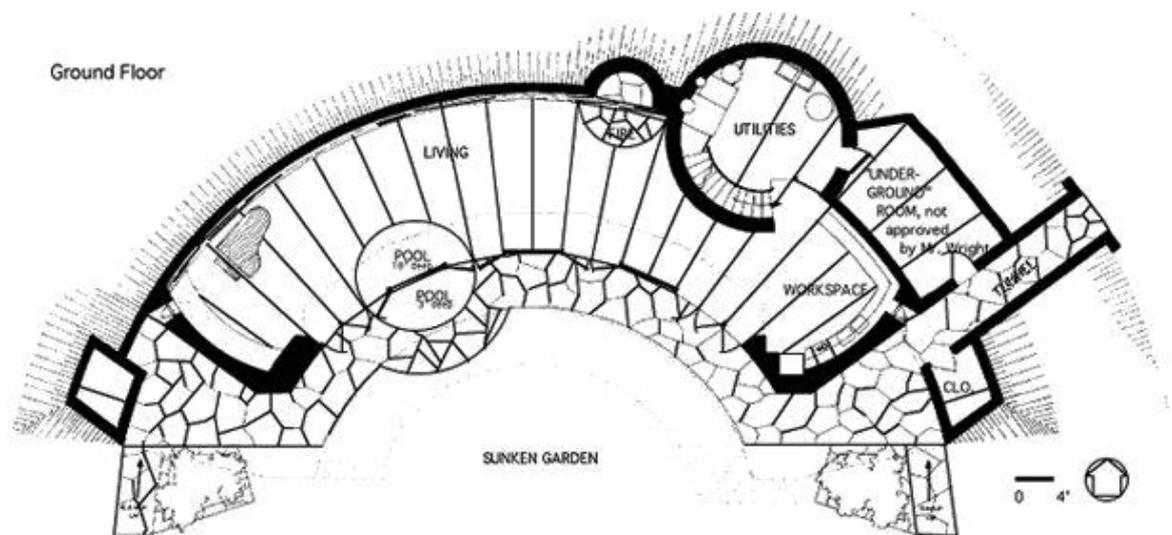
Jacobs House II, Grundriss, Quelle: [www.greatbuildings.com](http://www.greatbuildings.com)
